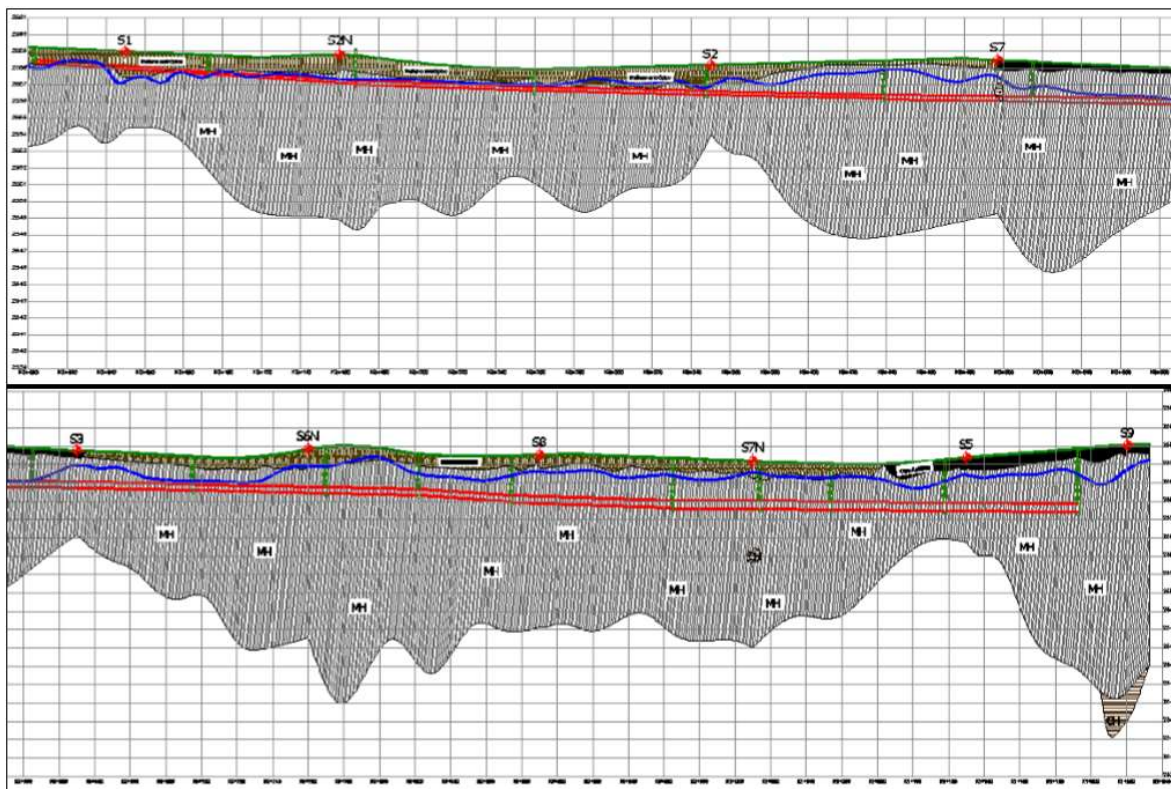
Perfil geotécnico de la calzada Oriental.
